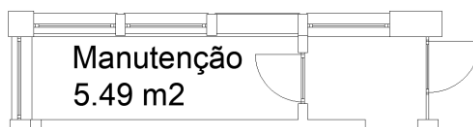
Planta em 2D da sala de manutenção da AE ISEC.
